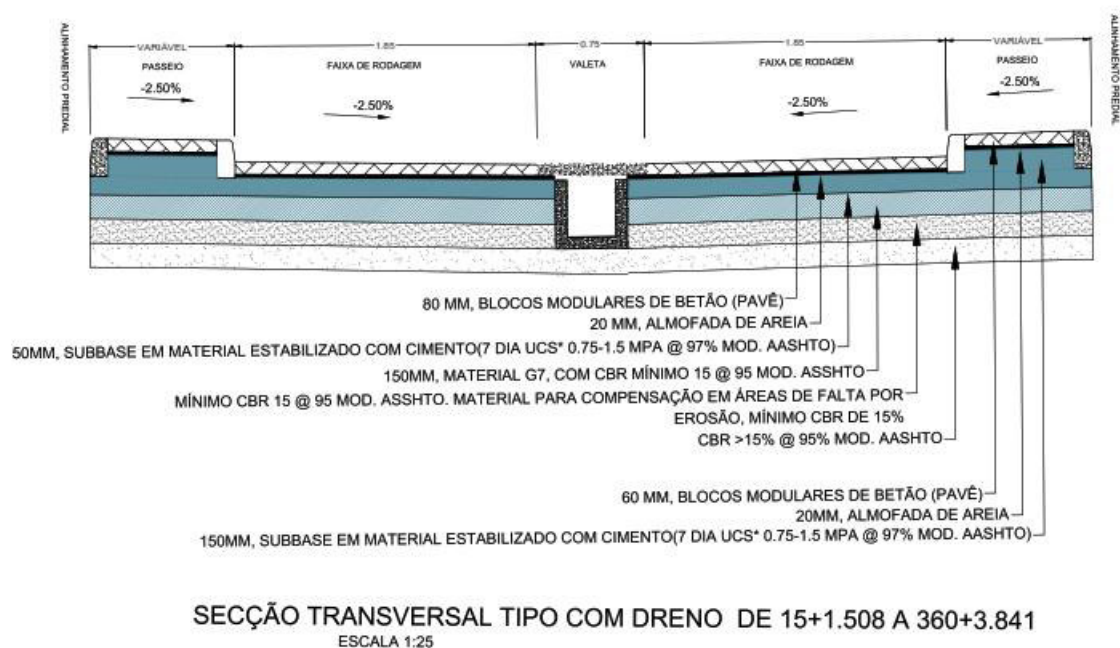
Secção da estrutura de pavimento recomendada (Vala Central Enterrada)
